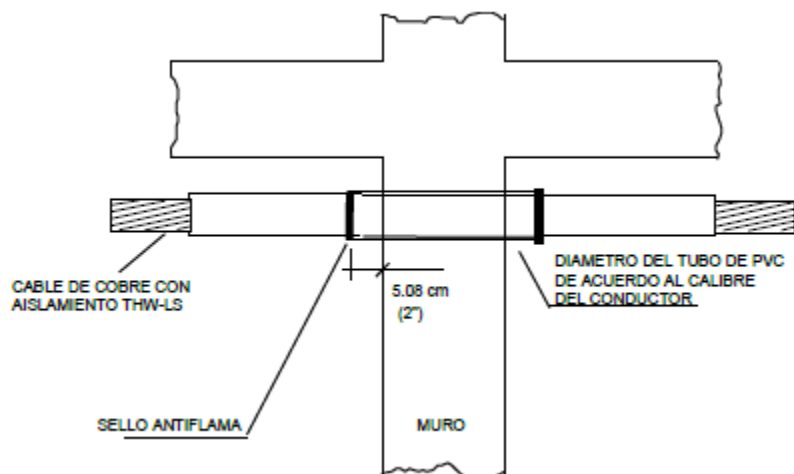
Paso del Cable por Muro Mediante Tubo Conduit de PVC.
